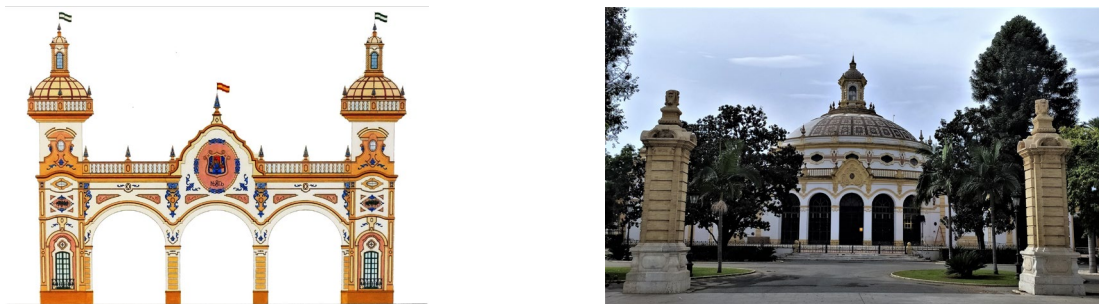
Portada de 1995 y fachada principal del Pabellón de Sevilla.
